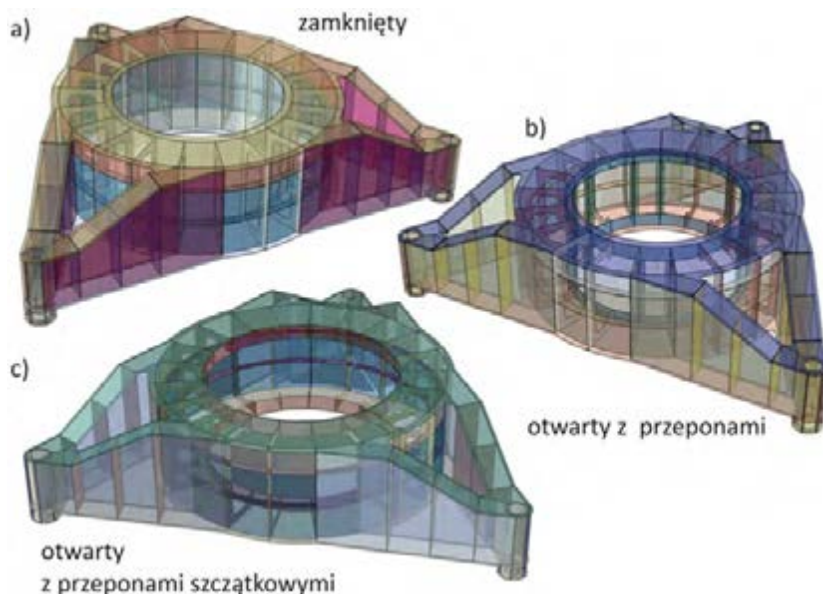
Przekroje poprzeczne dźwigara pierścieniowego:
